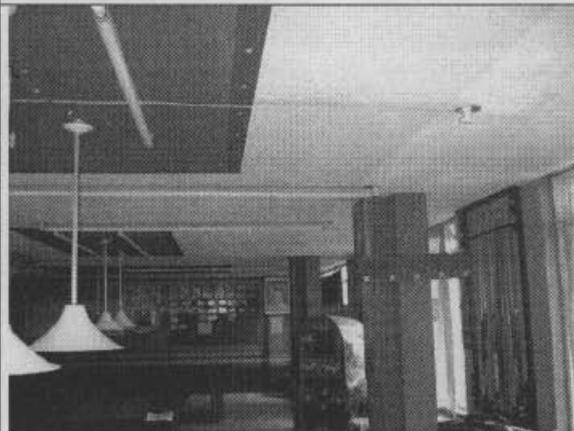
Pórticos y placa de entrepiso sin daños visibles
